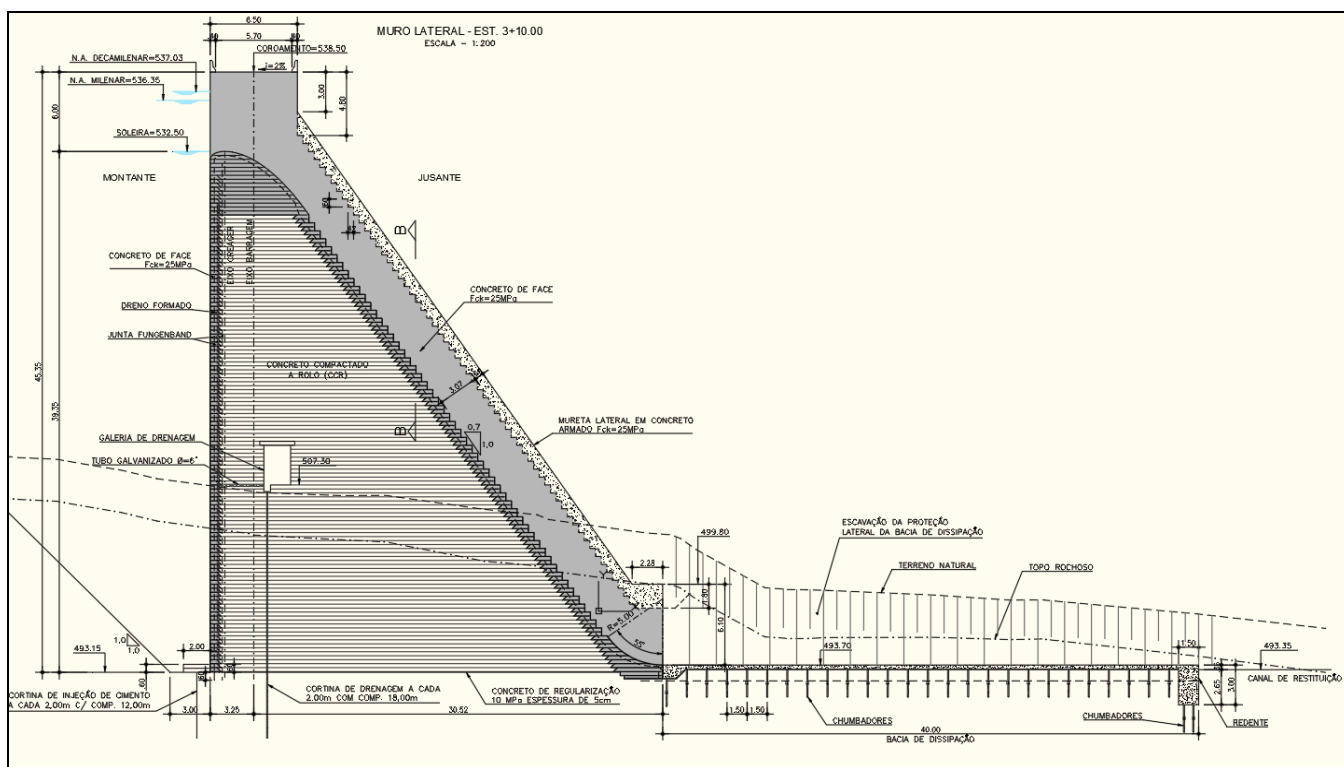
Seção tipo da barragem (submersível), vertedouro e bacia de dissipação
